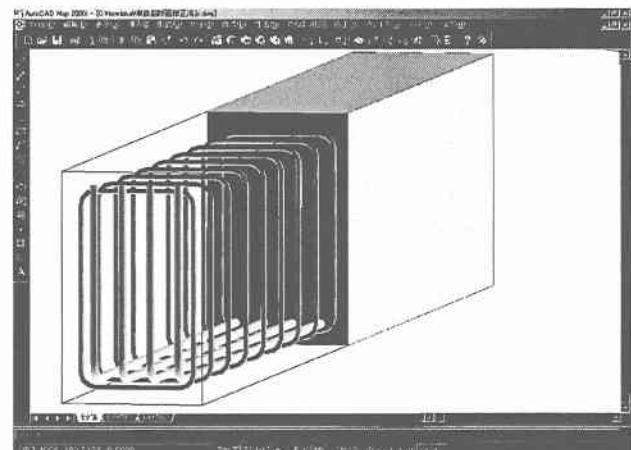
矩形断面 RC 梁の 3 次元 CAD イメージ
